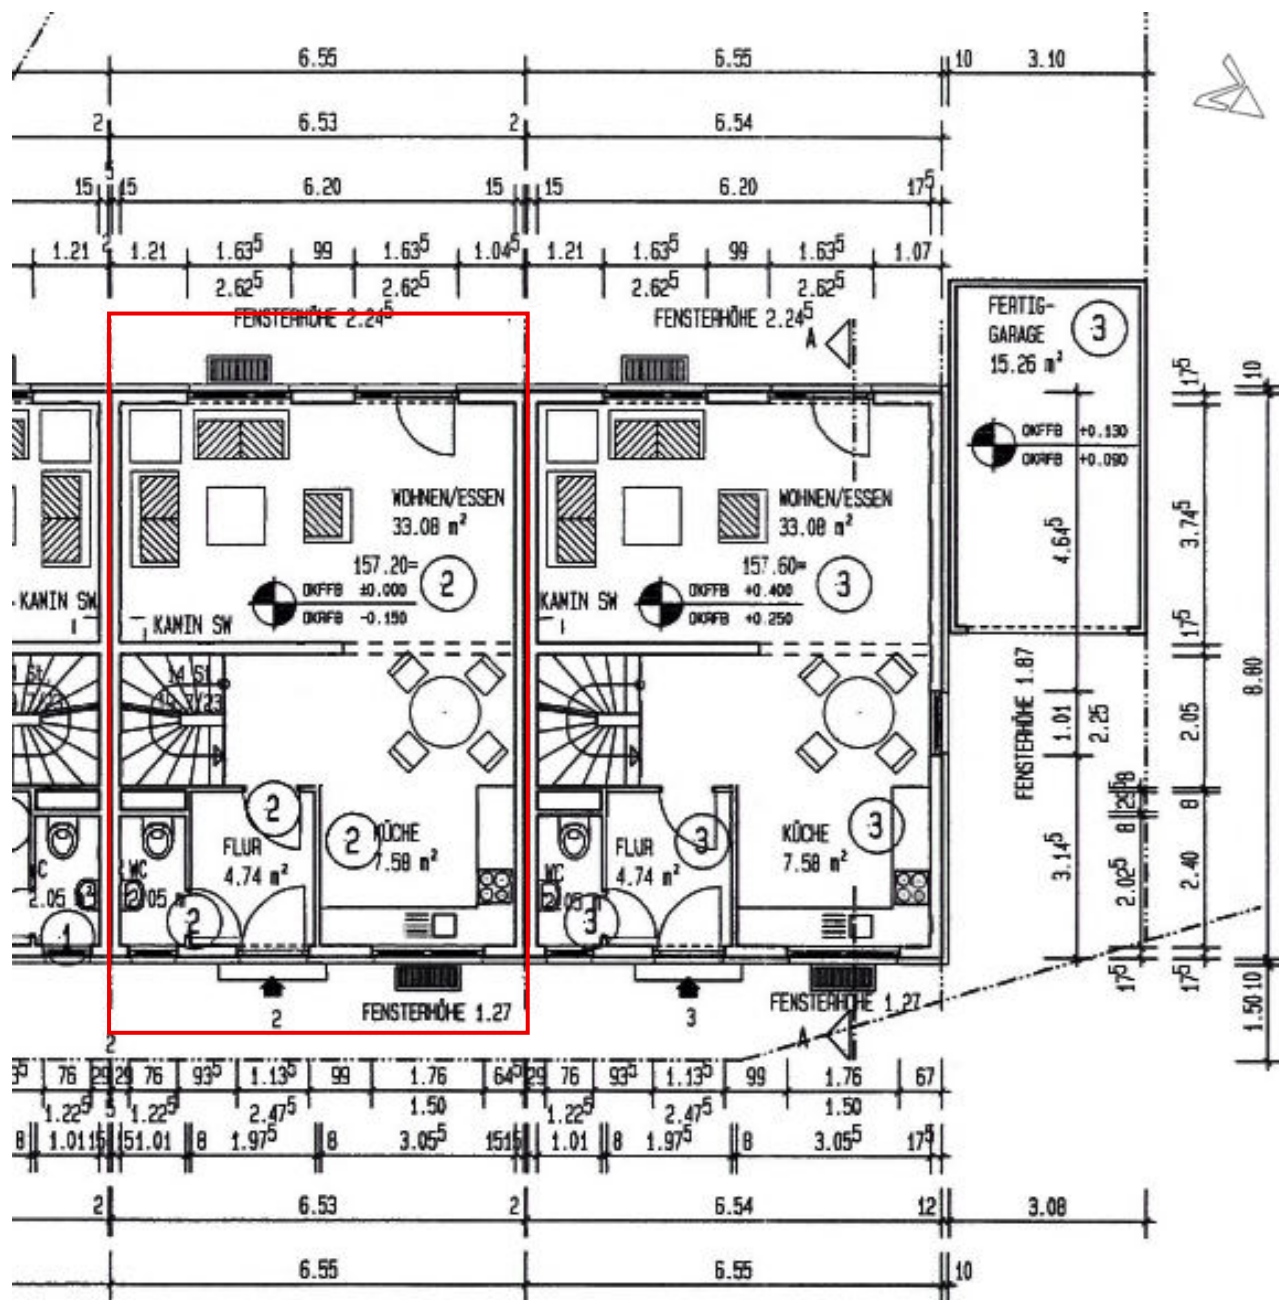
Grundriss Erdgeschoss (Ausschnitt ohne Maßstab); Detail Sondereigentum Nr. 2; Quelle: Bauakte; Roteintragung durch den SV
